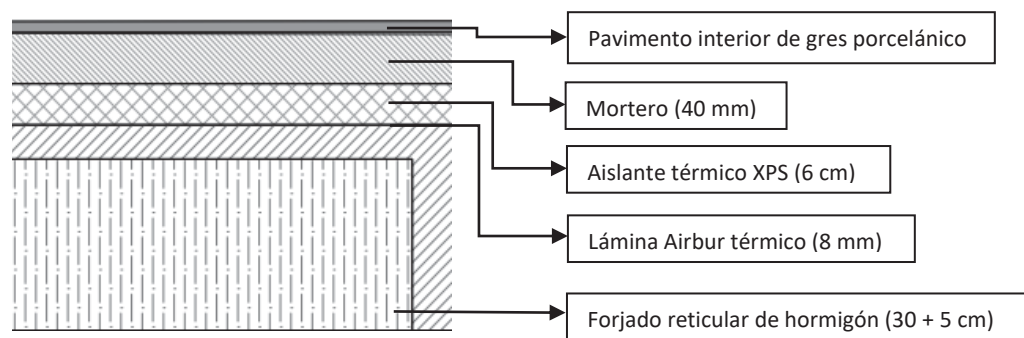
Esquema del elemento separador horizontal de la planta baja original del edificio.
